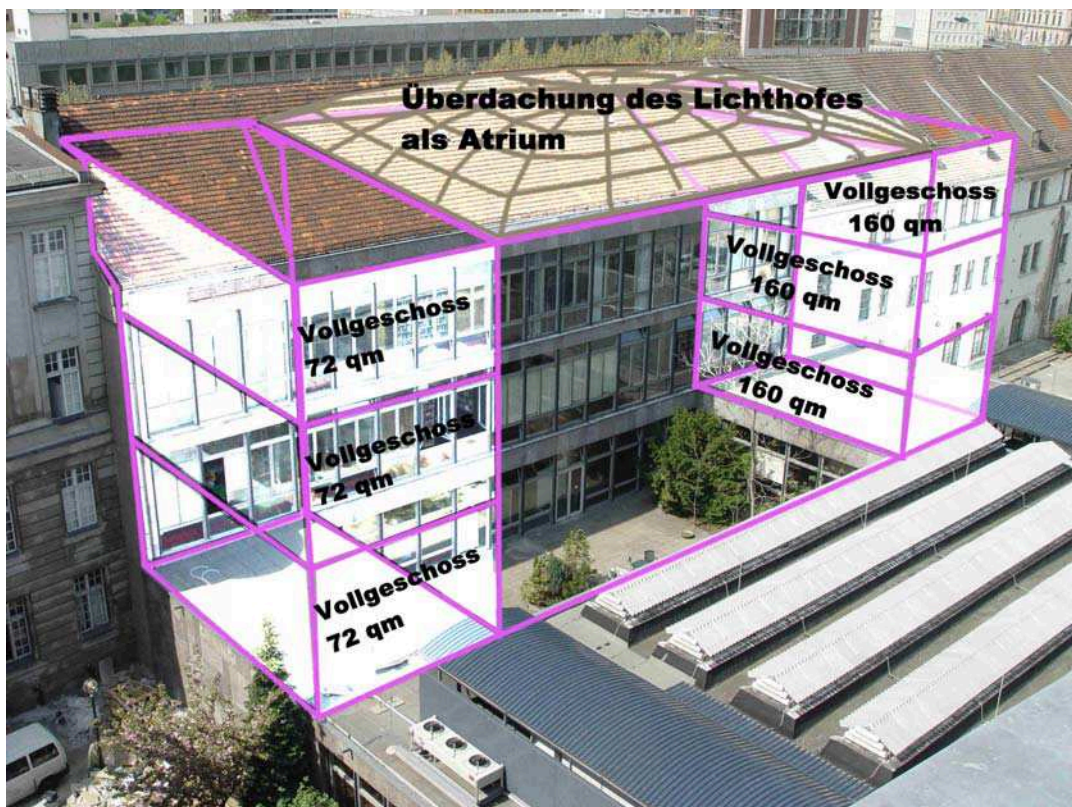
Gebäudeüberbauung mit 3 Vollgeschossen über den Verbindungsgängen zum Haus 1
